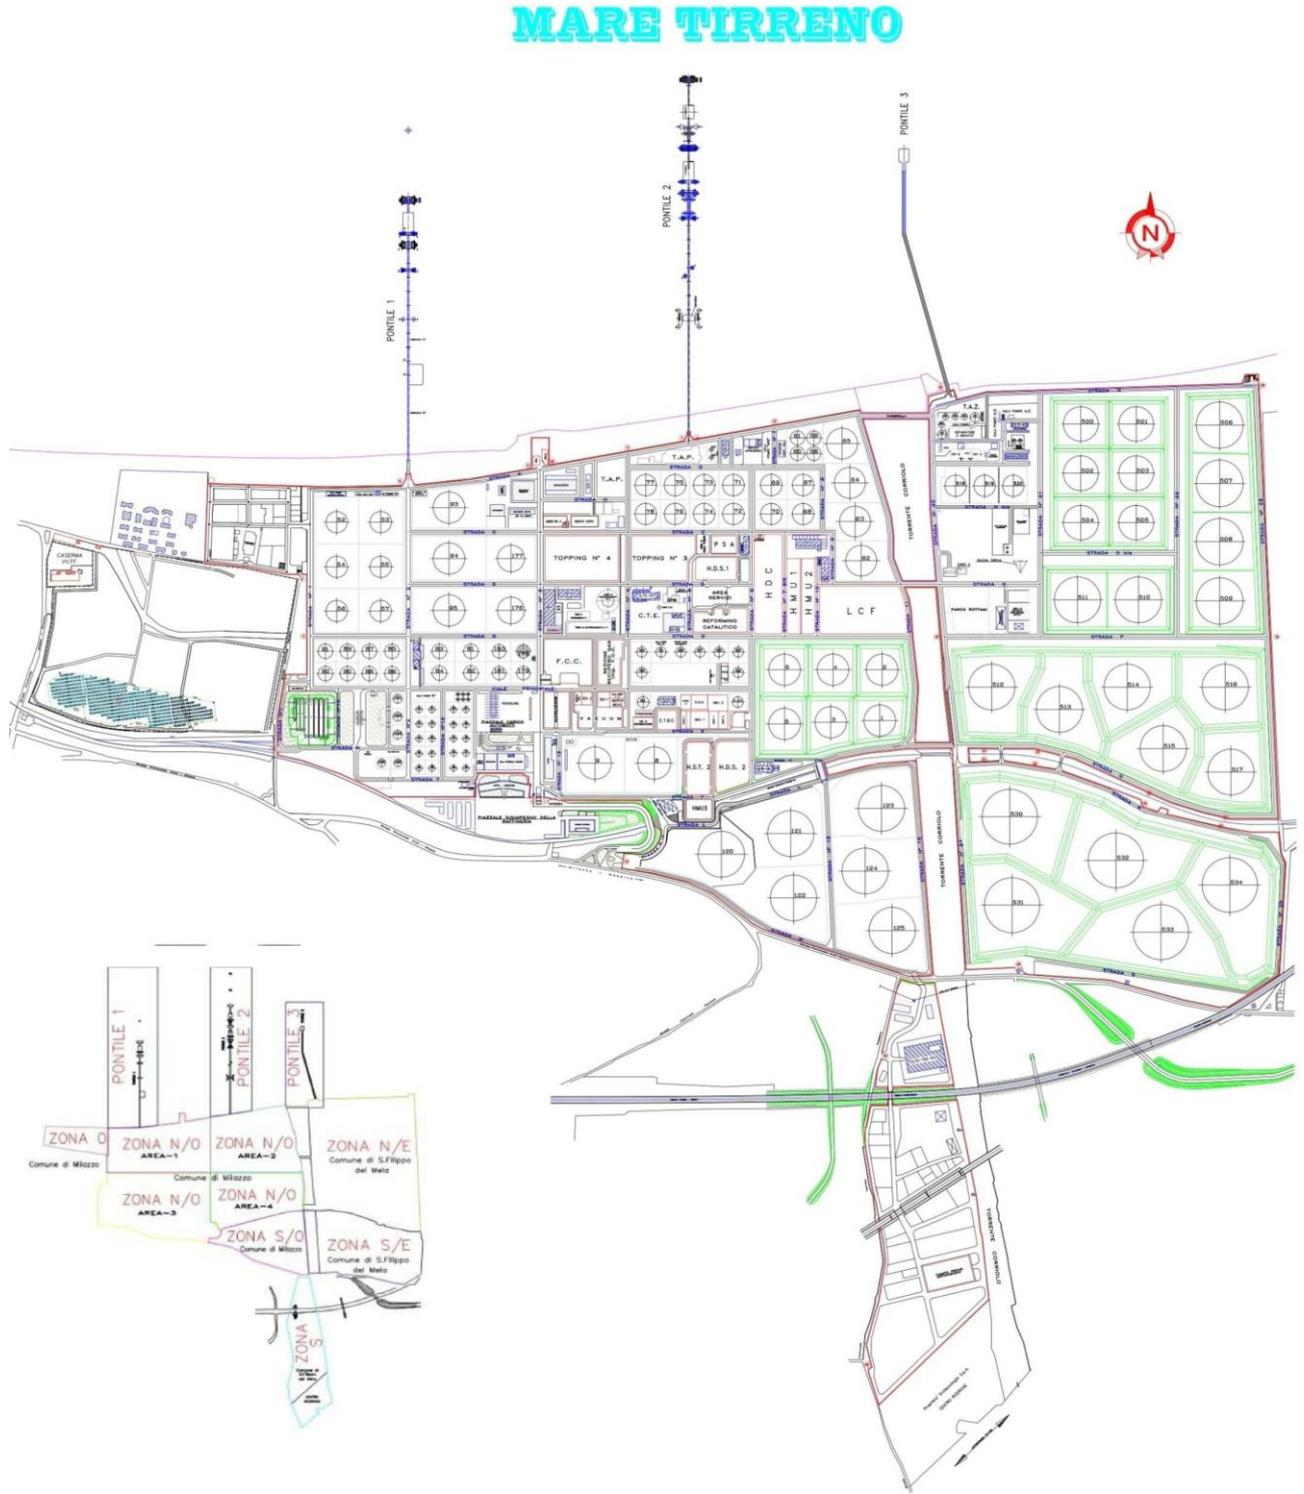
Planimetria Raffineria di Milazzo S.C.p.A.
